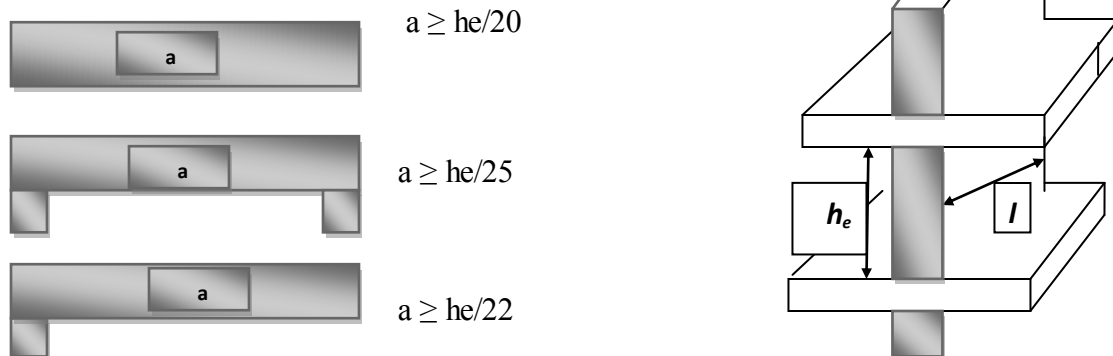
Coupe de voile en plan (gauche) Voile en 3D (droite)
